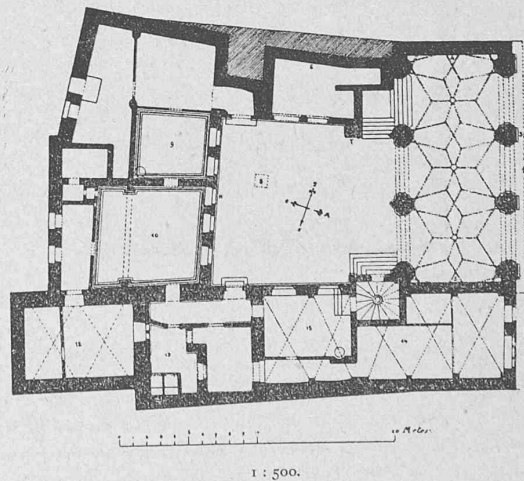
Grundriss vom Erdgeschoss.
